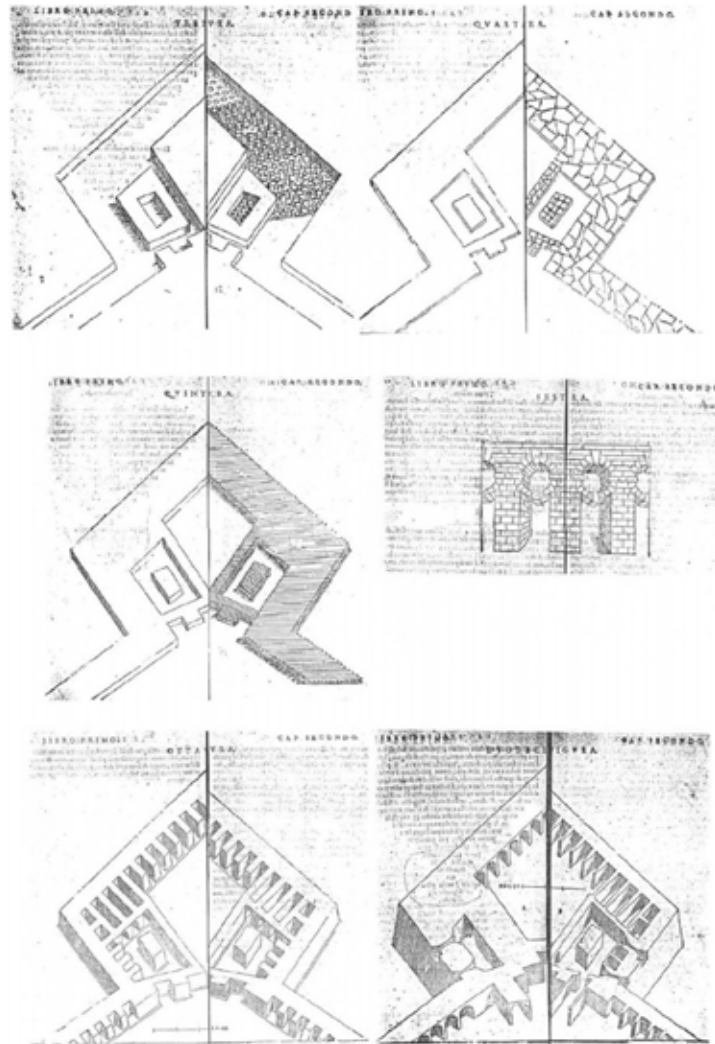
pianta e vista assonometrica delle strutture interne di un baluardo (fonte: Cataneo G. 1584).
